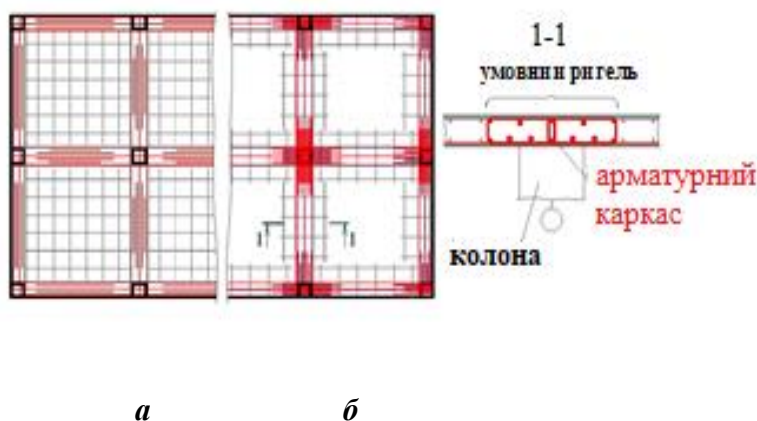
Армування залізобетонних монолітних плит перекриттів каркасно-монолітних будівель за «ригельною» розрахунковою схемою:
